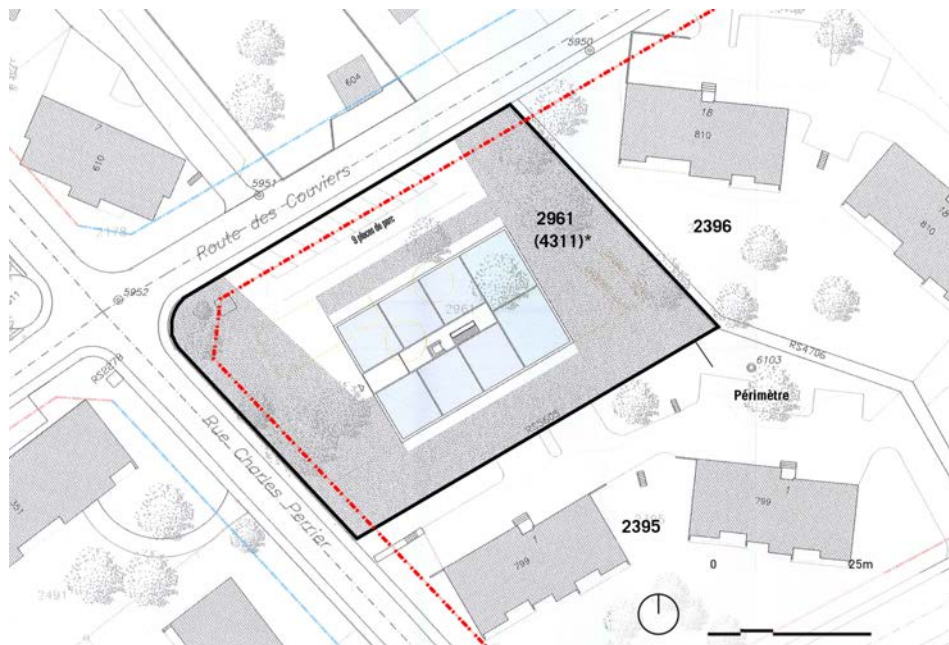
Variante d'implantation B (Source : ©GD architectes)
